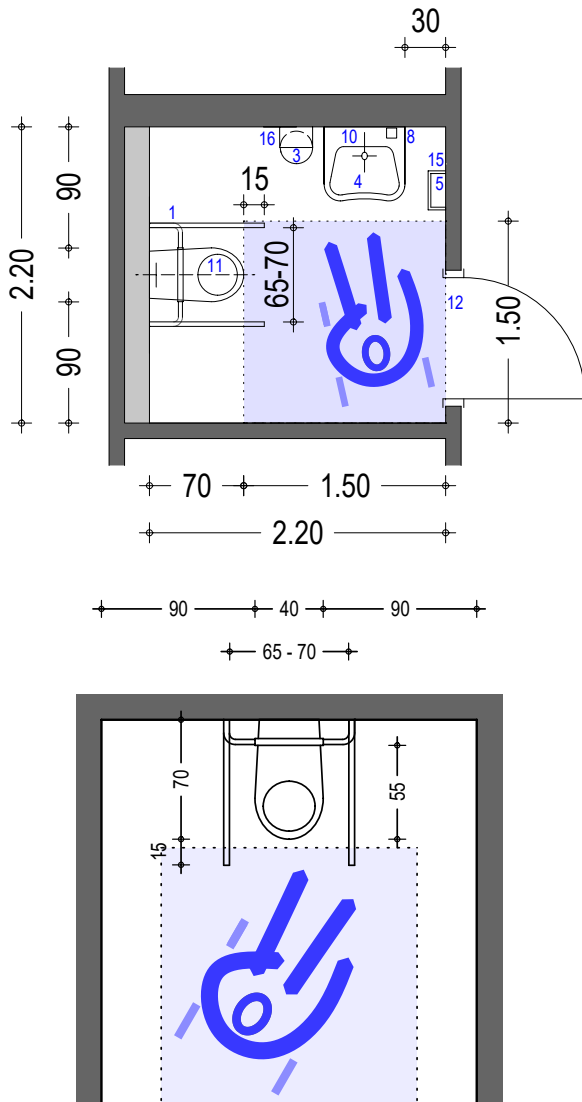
WC-Grundriss – Mindestabmessungen und Bewegungsflächen I und II
